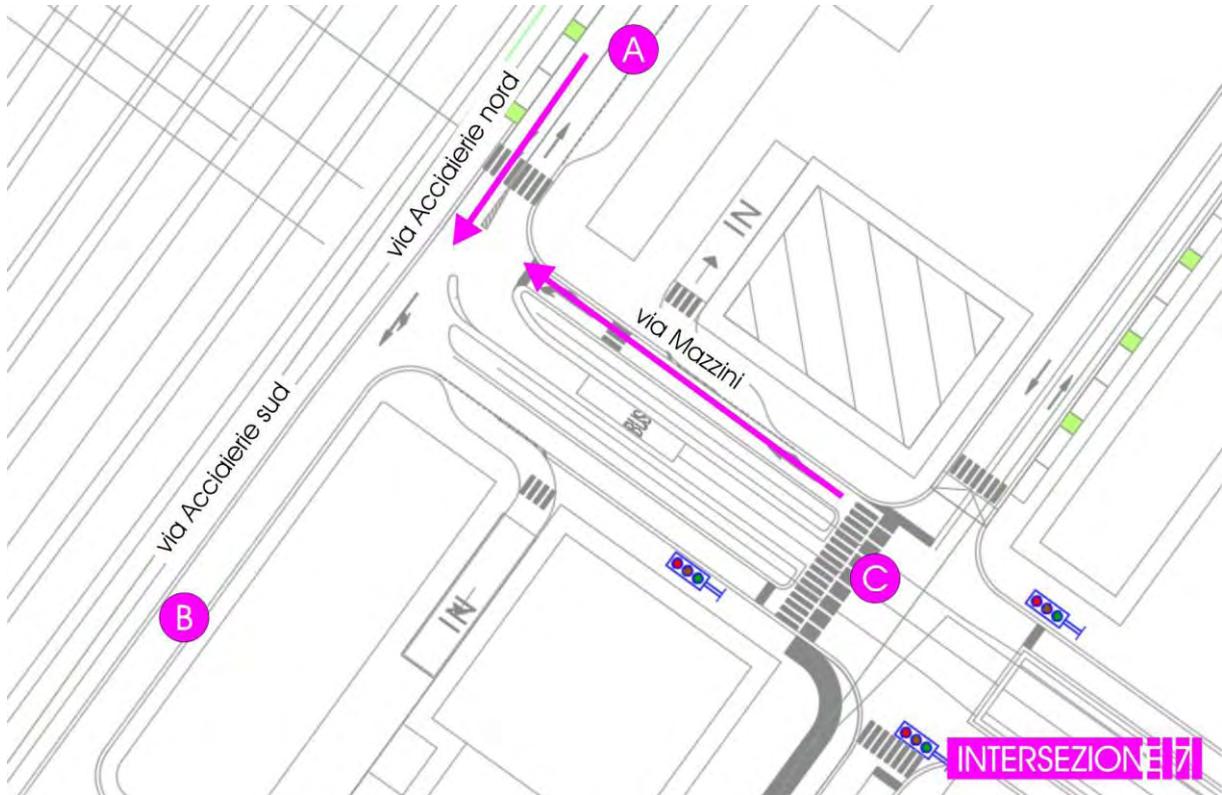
Scenario di Intervento 0 – Planimetria intersezione 7
